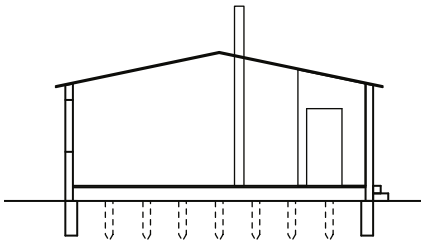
Baukastenbauweise des RAD-Holzhauses.
